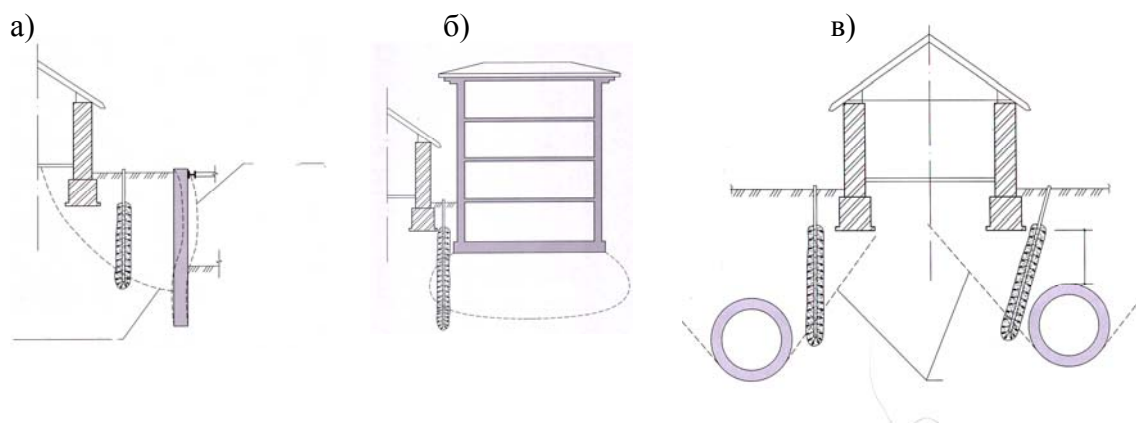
Защита фундаментов существующего здания с помощью геотехнического барьера
